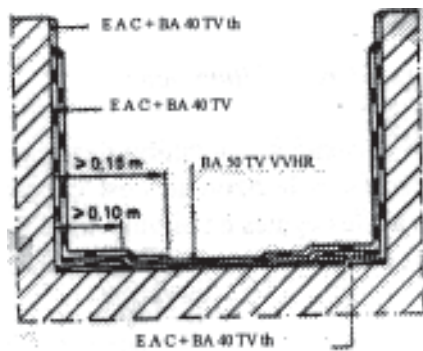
Chéneau revêtu d'étanchéité multicouche
